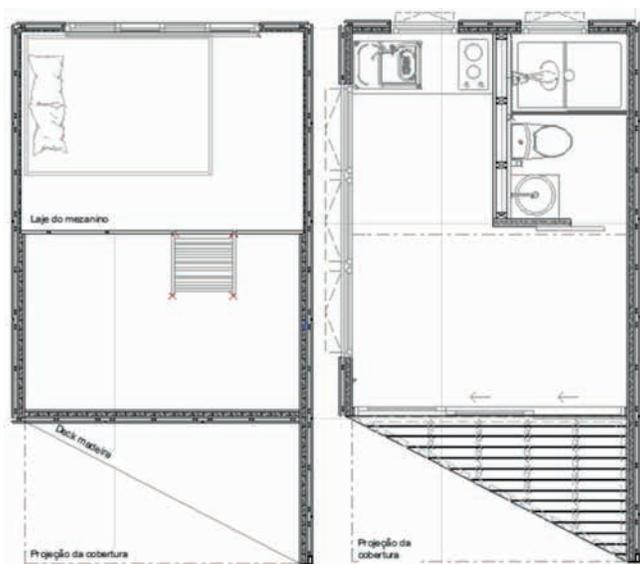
Planta do térreo e planta do mezanino da “Casa 12”
